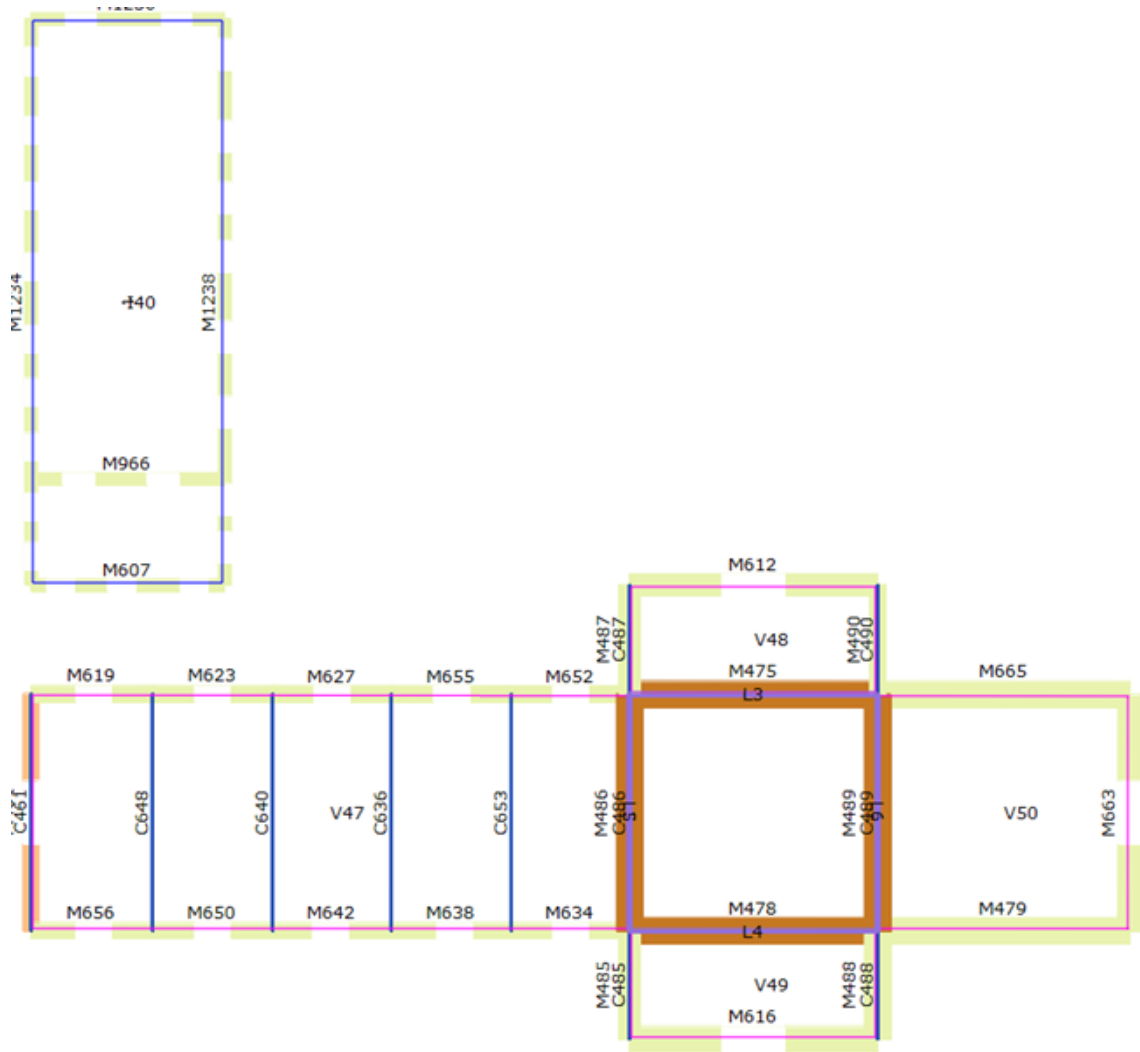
Planimetria livello 4 (15.70 – 18.90 m).
